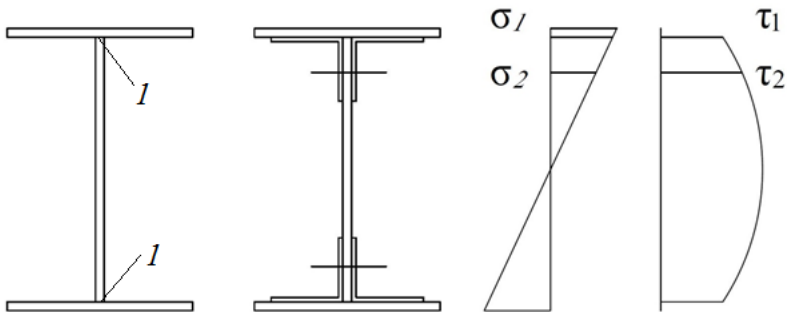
Распределение нормальных и касательных напряжений по высоте сечения поперечной баки
